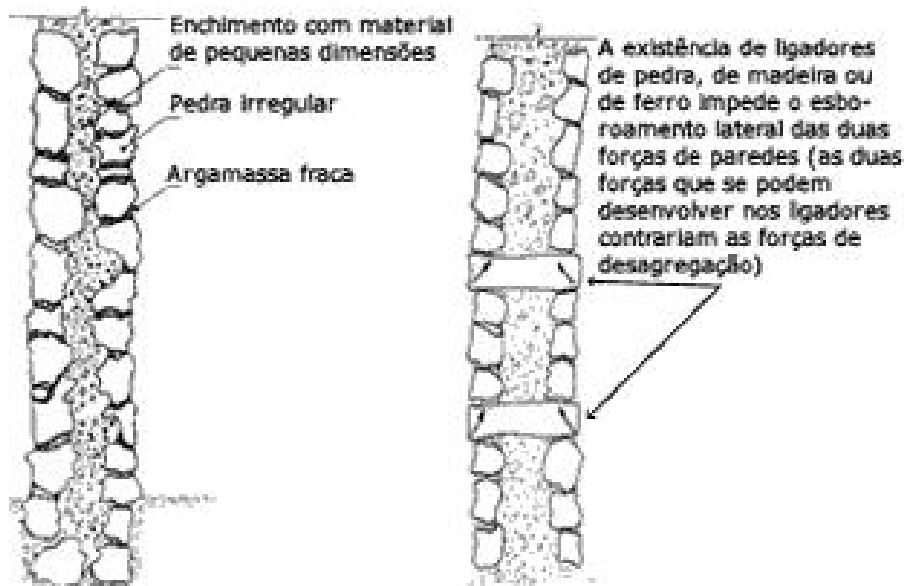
Alvenaria de pedra de duas faces, com e sem travamento.
